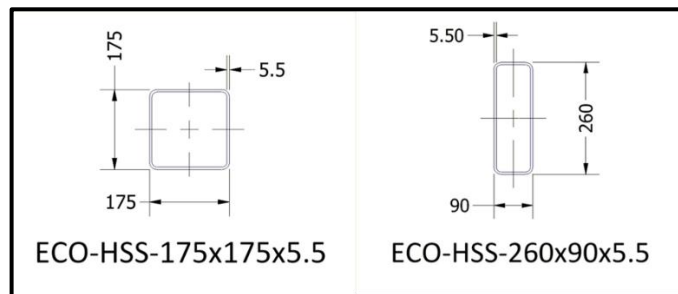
Perfiles empleados en la conexión de estudio para la columna (izq.) y la viga (der.).
